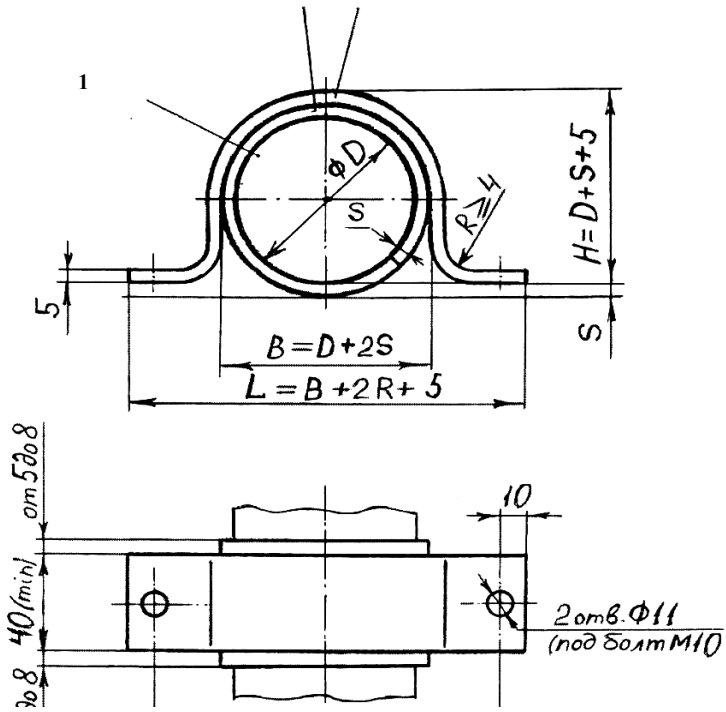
Крепление одного кабеля к металлоконструкции.
